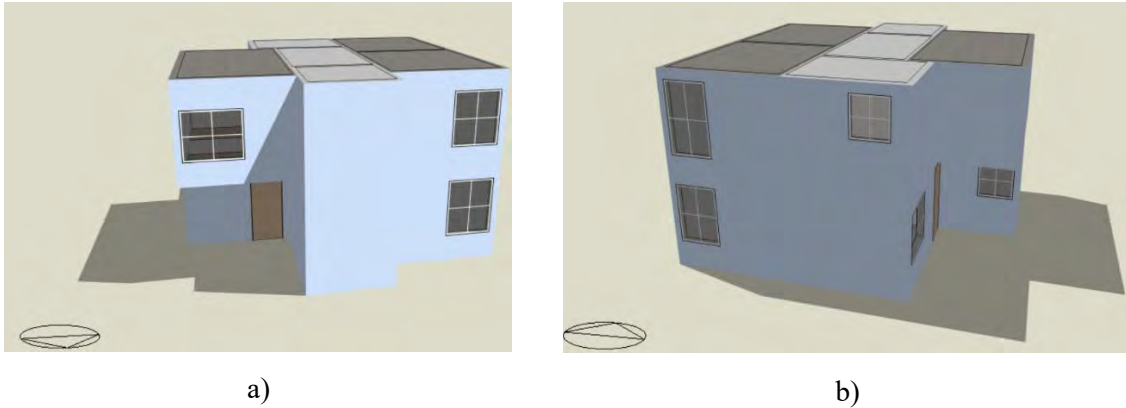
Fachadas de la viviendas a) norte, b) sur.
